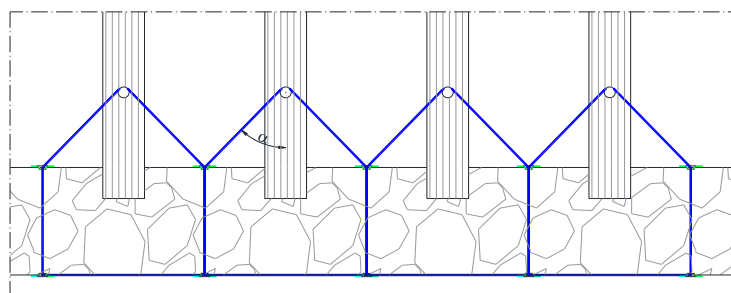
L'arpionatura dei travetti del solaio: disposizione in pianta
